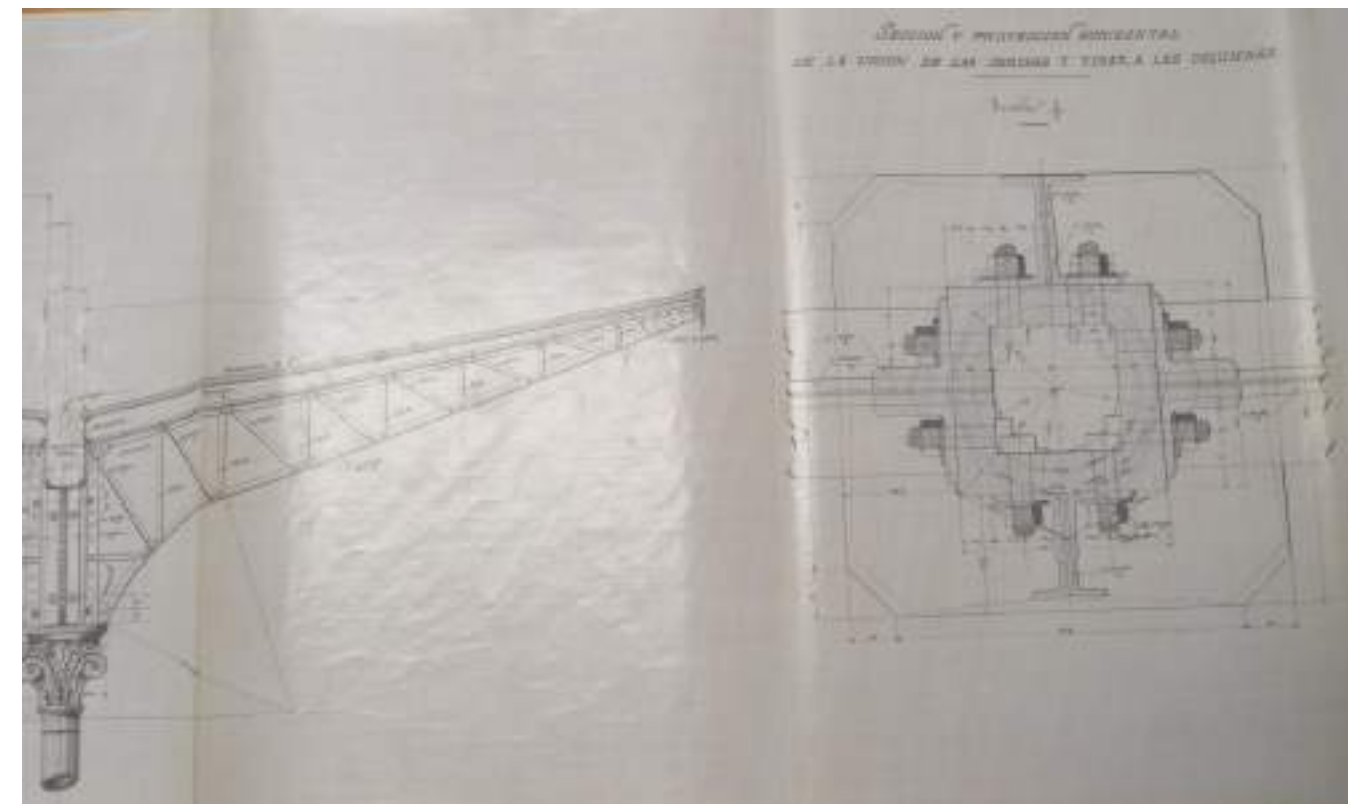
Alzado de las cerchas sobre columnas. Sección y proyección horizontal de la unión de las cerchas y vigas a las columnas (Escala 1:20), 1905, en "Proyecto de marquesinas para los andenes laterales del nuevo edificio de viajeros". AHF-MFM signatura B-0057-006 1-16.
